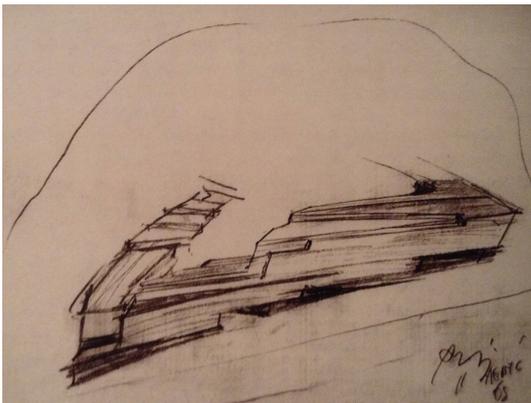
Estudo de Álvaro Siza, para a Avenida da Ponte, lado nascente, proposta de 1968
